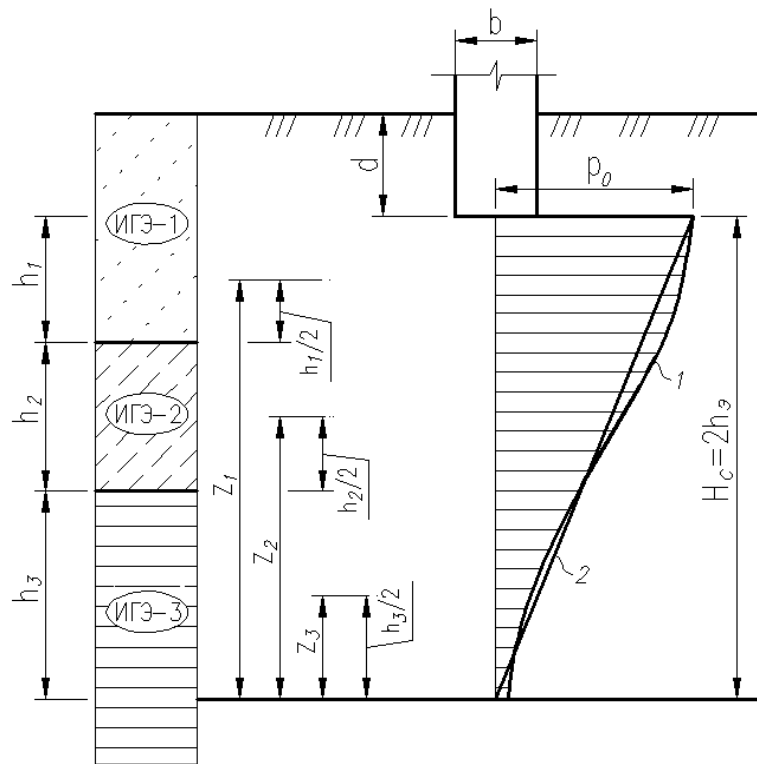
Схема к расчету осадки методом эквивалентного слоя для слоистого напластования грунтового основания: 1 – криволинейная эпюра дополнительных напряжений по оси фундамента; 2 – эквивалентная по площади треугольная эпюра с вершиной на глубине $2h_3$ от уровня подошвы фундамента; z_i – расстояние от середины рассматриваемого слоя до глубины $2h_3$
